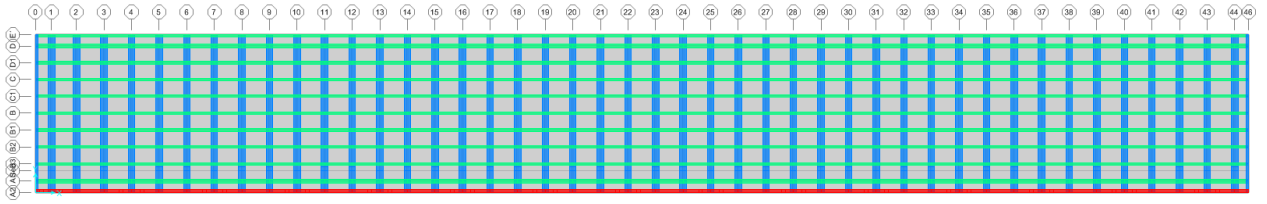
Vista en planta de modelación, paralelo a plano X-Y.
